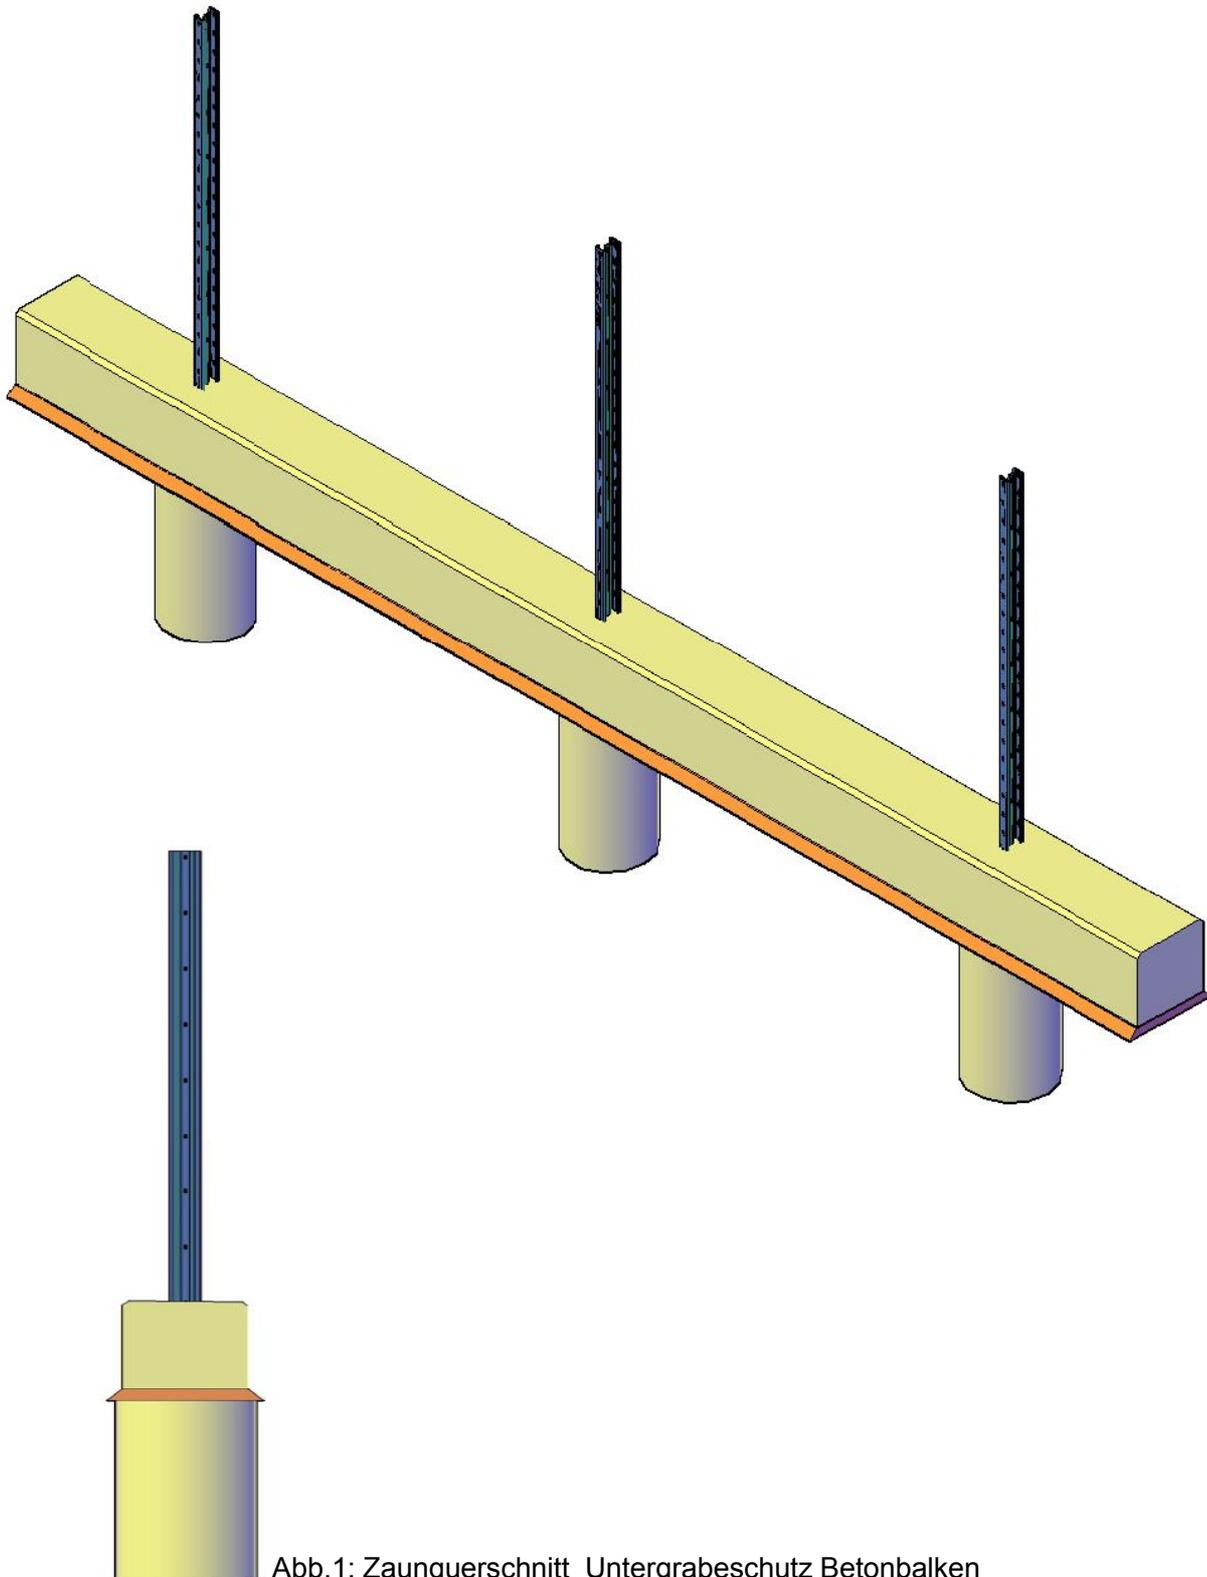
Zaunquerschnitt Untergrabeschutz Betonbalken
